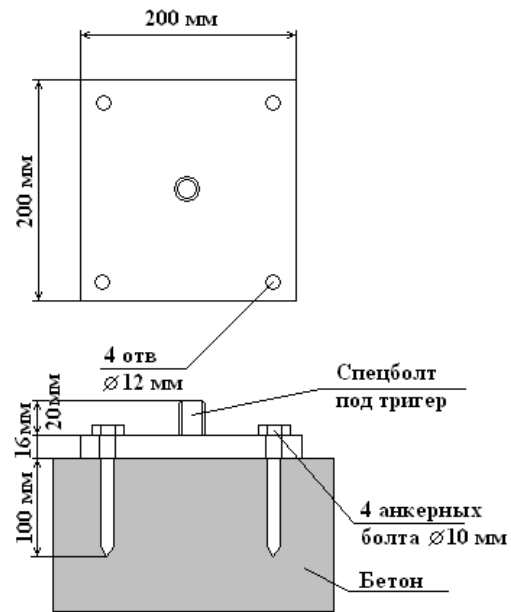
Конструкция геодезических пунктов сети на крыше здания № 13
